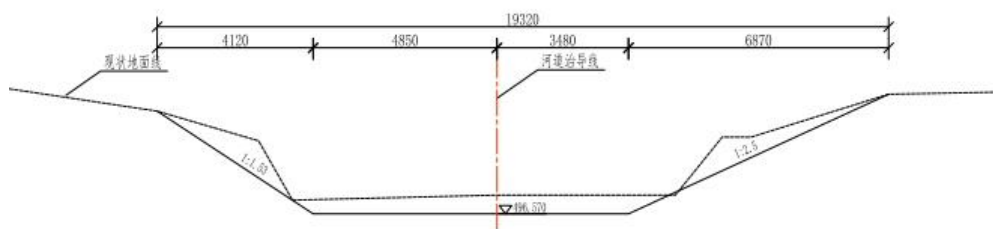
西拨子河东支桩号 1+400 断面设计横断面图
